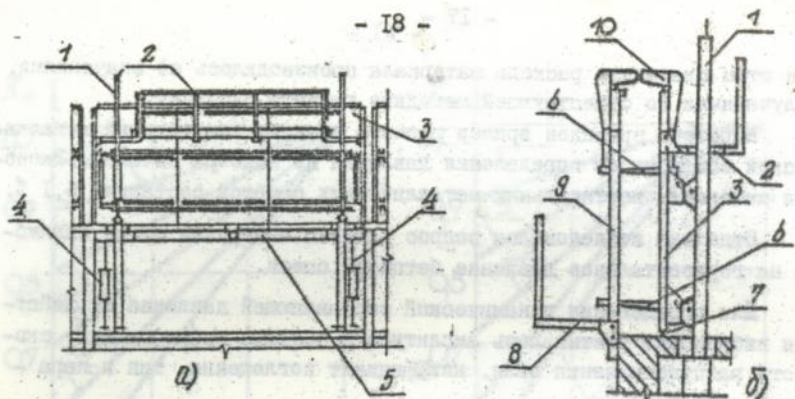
Подъемно-передвижная опалубка для возведения стен и перекрытий зданий:
